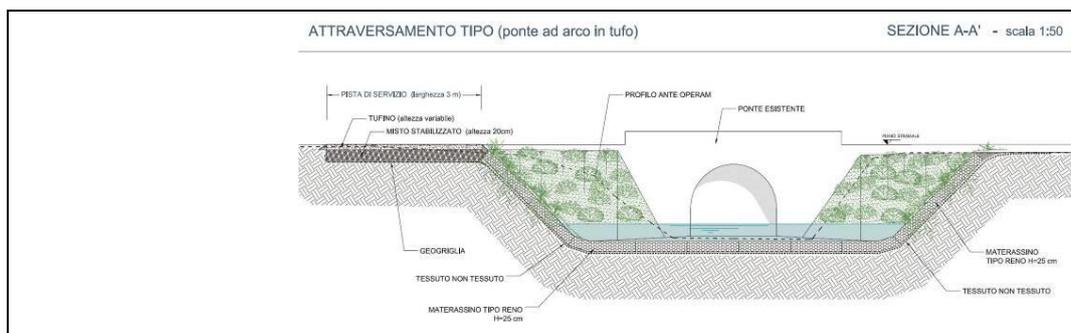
Sistemazione attraversamento tipo ponte in tufo esistente con materassi tipo Reno
